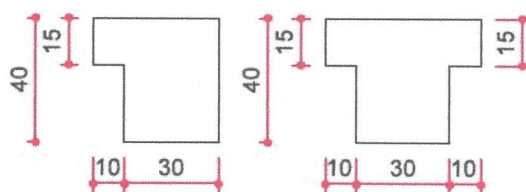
Seção transversal das Vigas Pré-moldadas.
